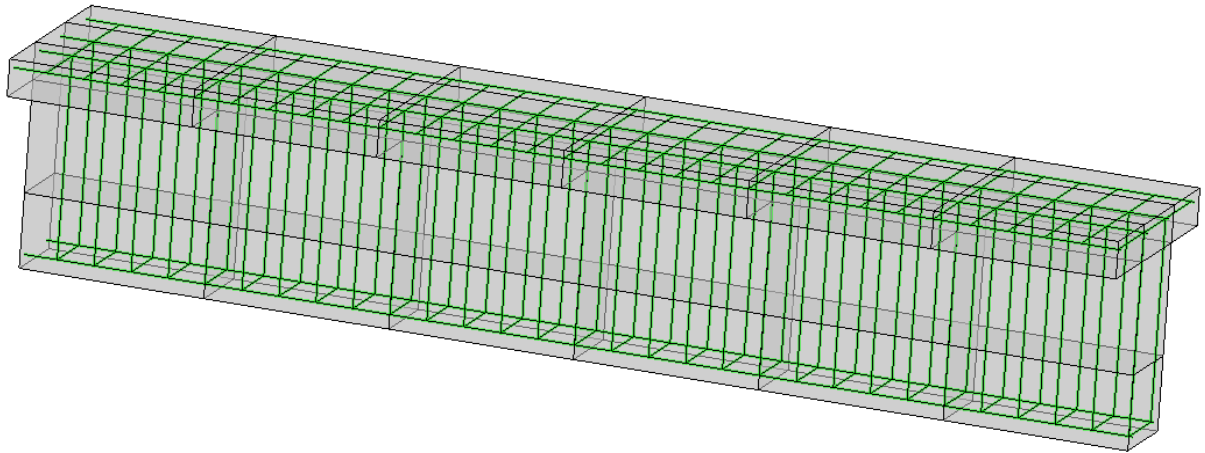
Malha dos elementos da armadura passiva para a viga.
